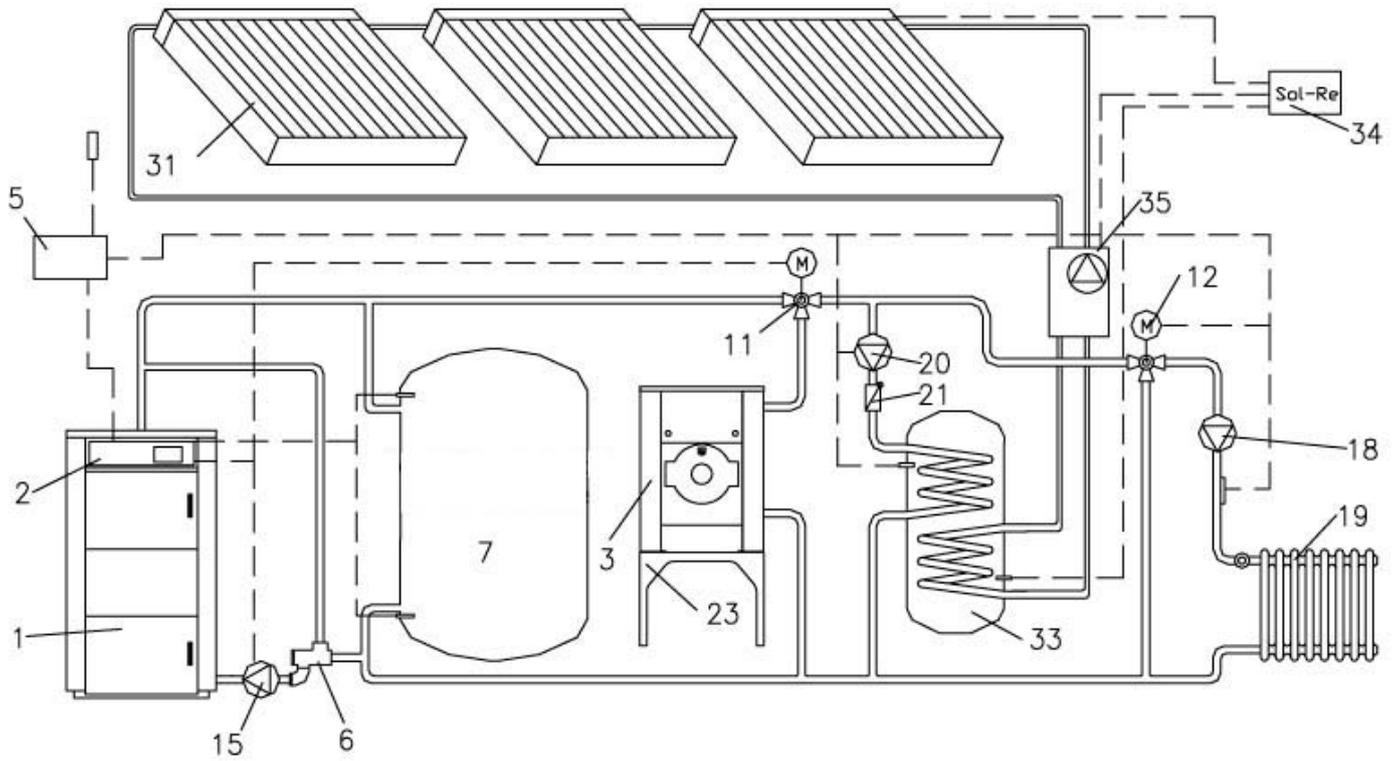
Sonderanlage 8: Holz-Öl-Heizungsanlage mit nebenstehendem Boiler und solarer Brauchwasserbereitung
